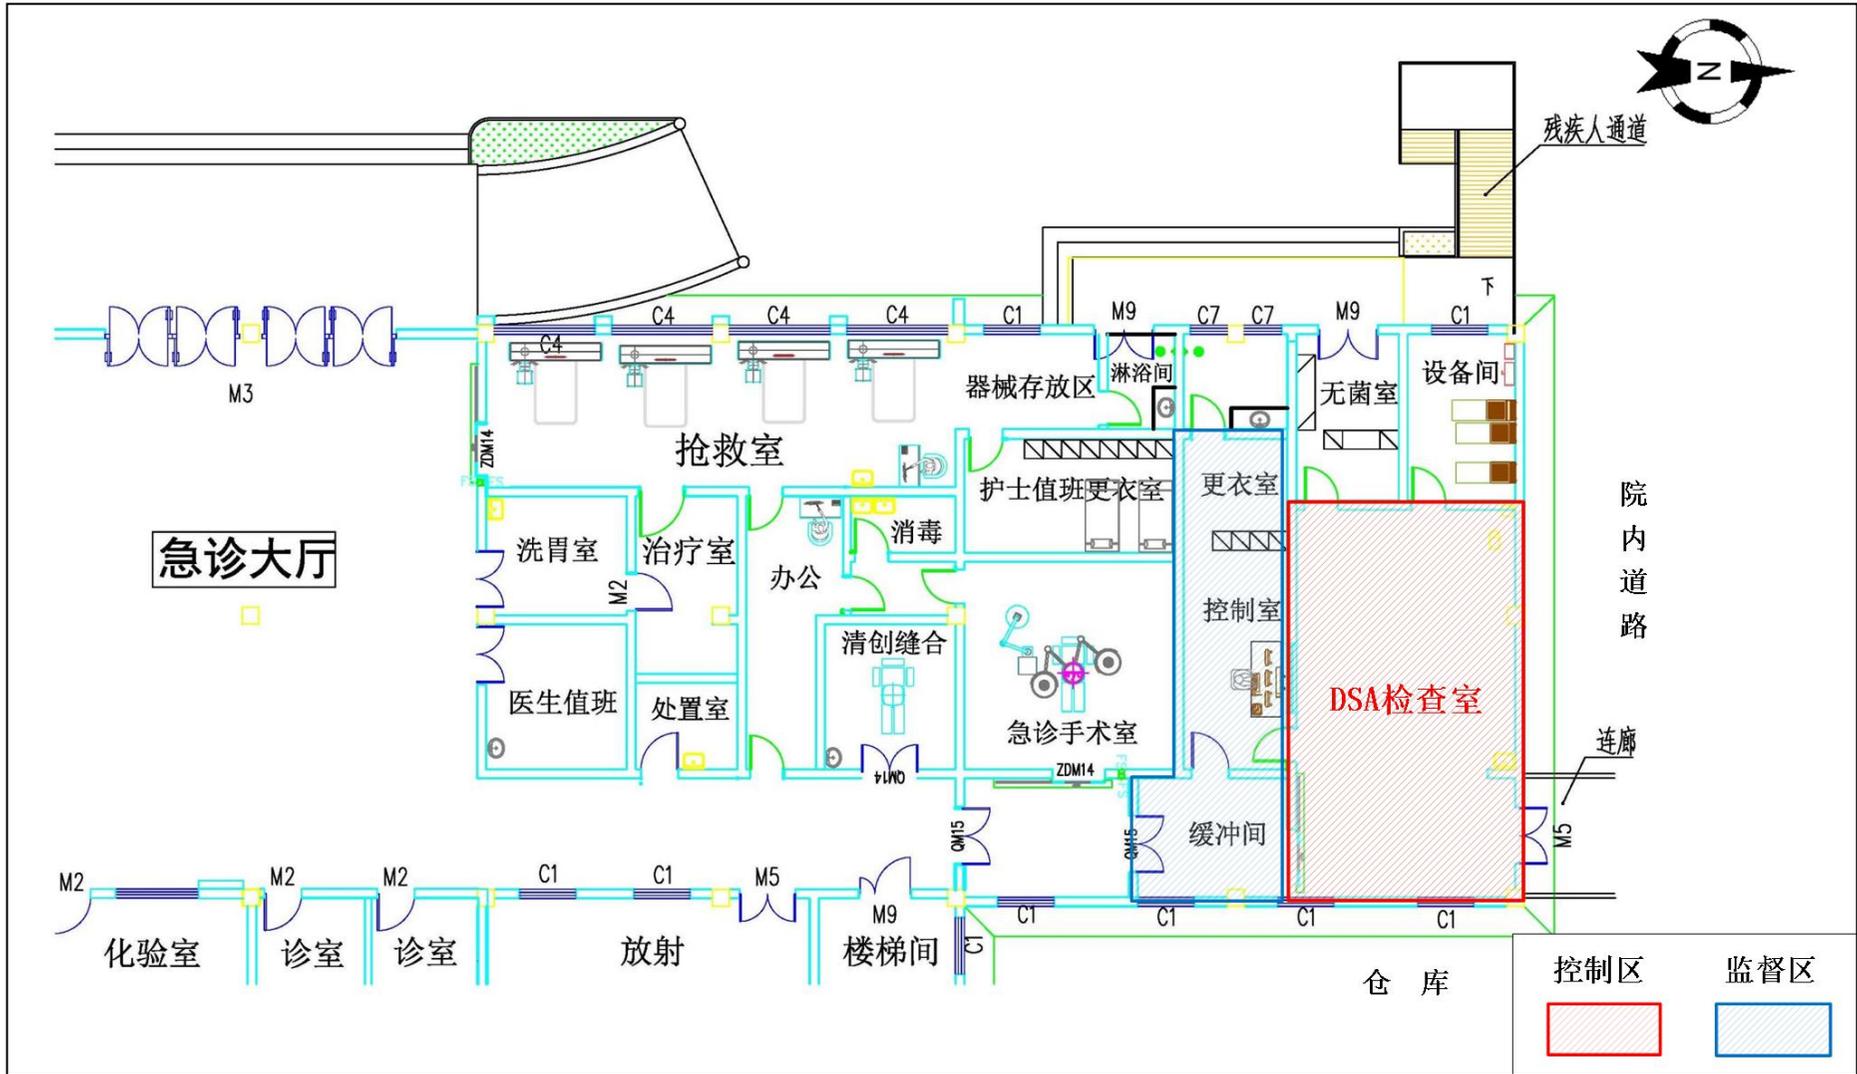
本项目 DSA 机房（检查室）平面布置及分区示意图
